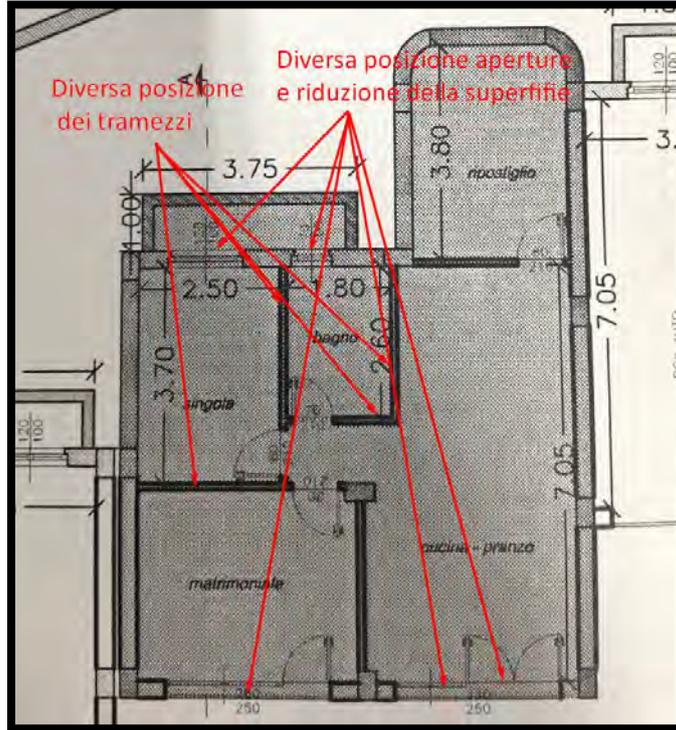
Pianta piano terzo allegata alla SCIA prot. n. 4418 del 01/06/2011
